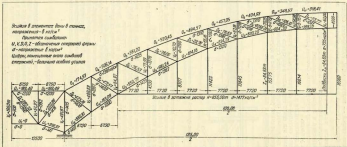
Свая формы гидравлического проекта моста через Хинганские водохранилища.
